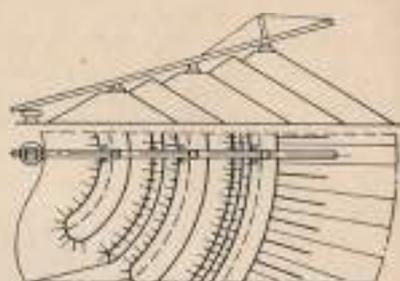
Схема отсыпки поворотными колесными отвалообразователями
